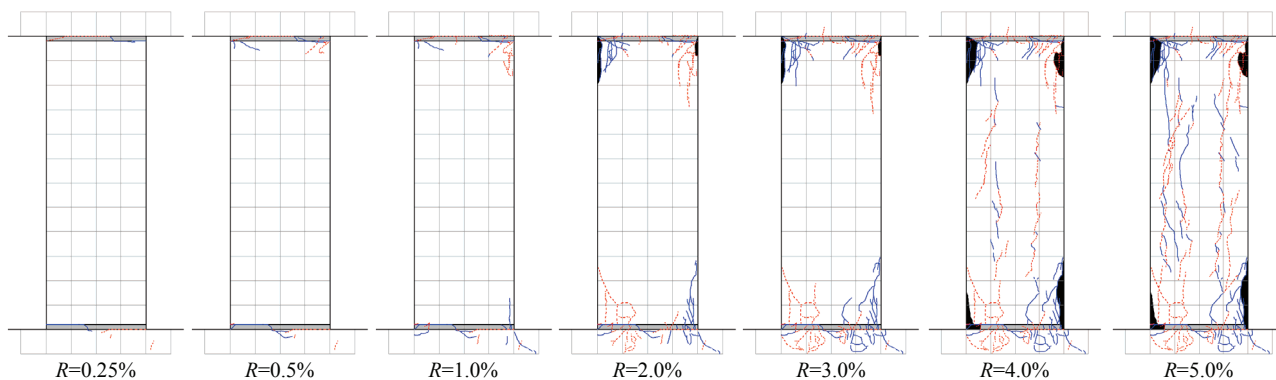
B1/3-0.1 ひび割れ状況
